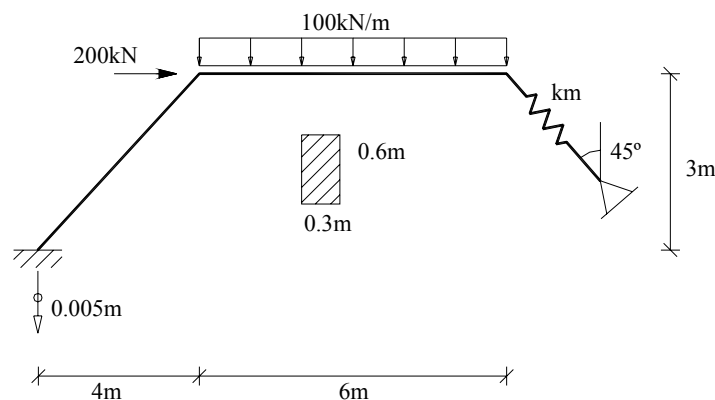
Pórtico plano (teoria de Timoshenko).
